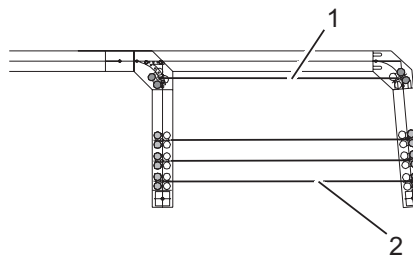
Rangement des vantaux dans la gare de rangement (exemple)
